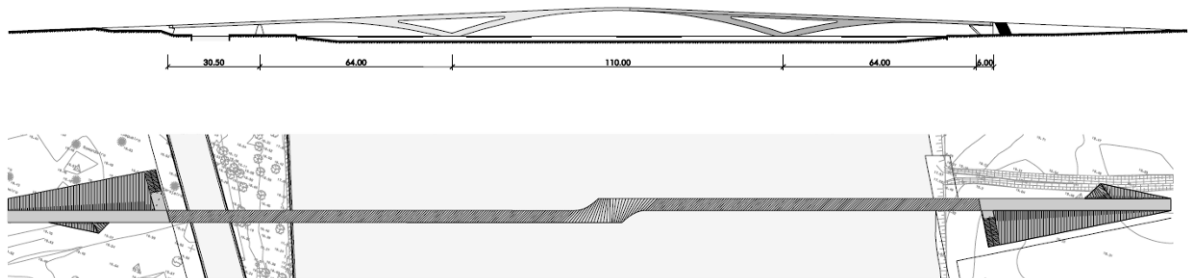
Planta e elevação da passarela Pedro e Inês [10].
